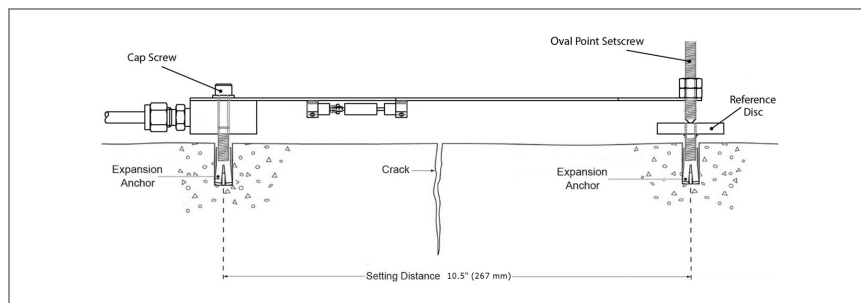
Ensamblaje del medidor de grietas usando un disco de referencia y dos anclajes
